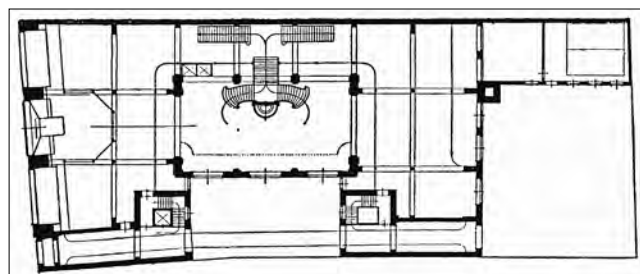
Berlin, Warenhaus Wertheim, Oranienstraße 53–54, Grundriss, zerstört
